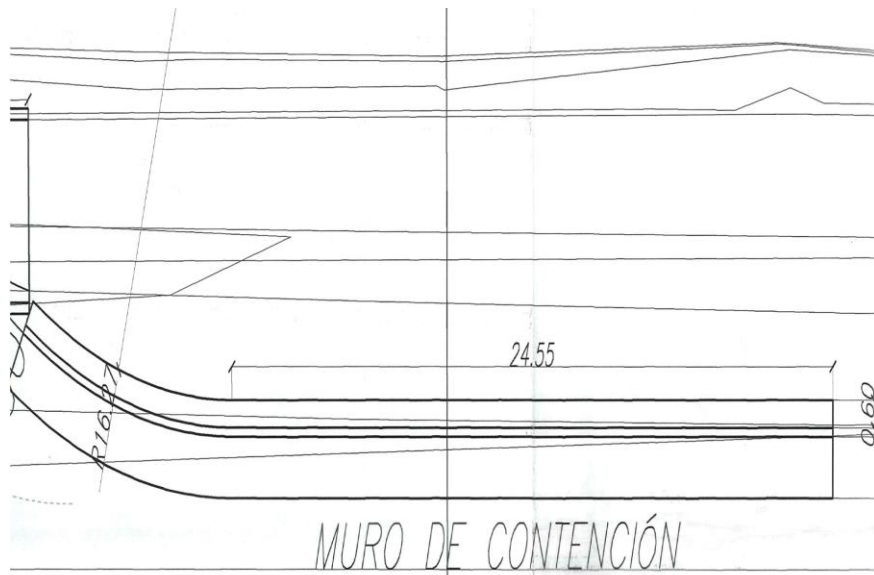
Planta muro de contención canal aguas lluvias vía doble calzada.
